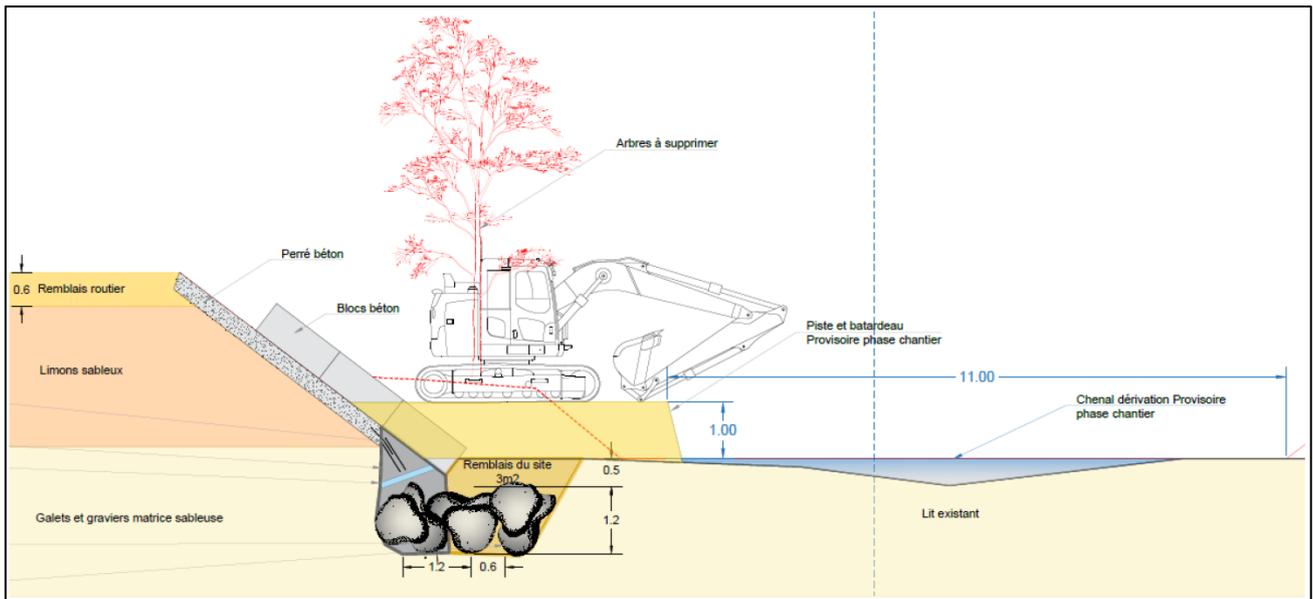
Coupe de la piste et du batardeau en rive gauche et du chenal de dérivation en rive droite, en phase travaux
